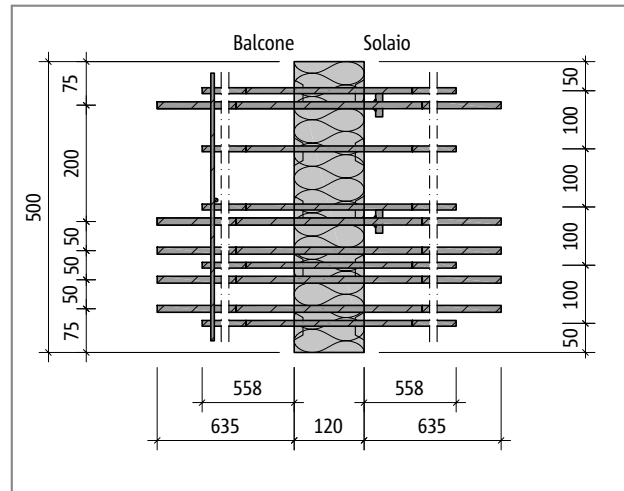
Schöck Isokorb® tipo EXT30-R-V10: pianta del prodotto
